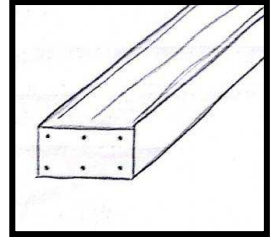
Escasa longitud de anclaje en negativos. Fuente: Propia.
